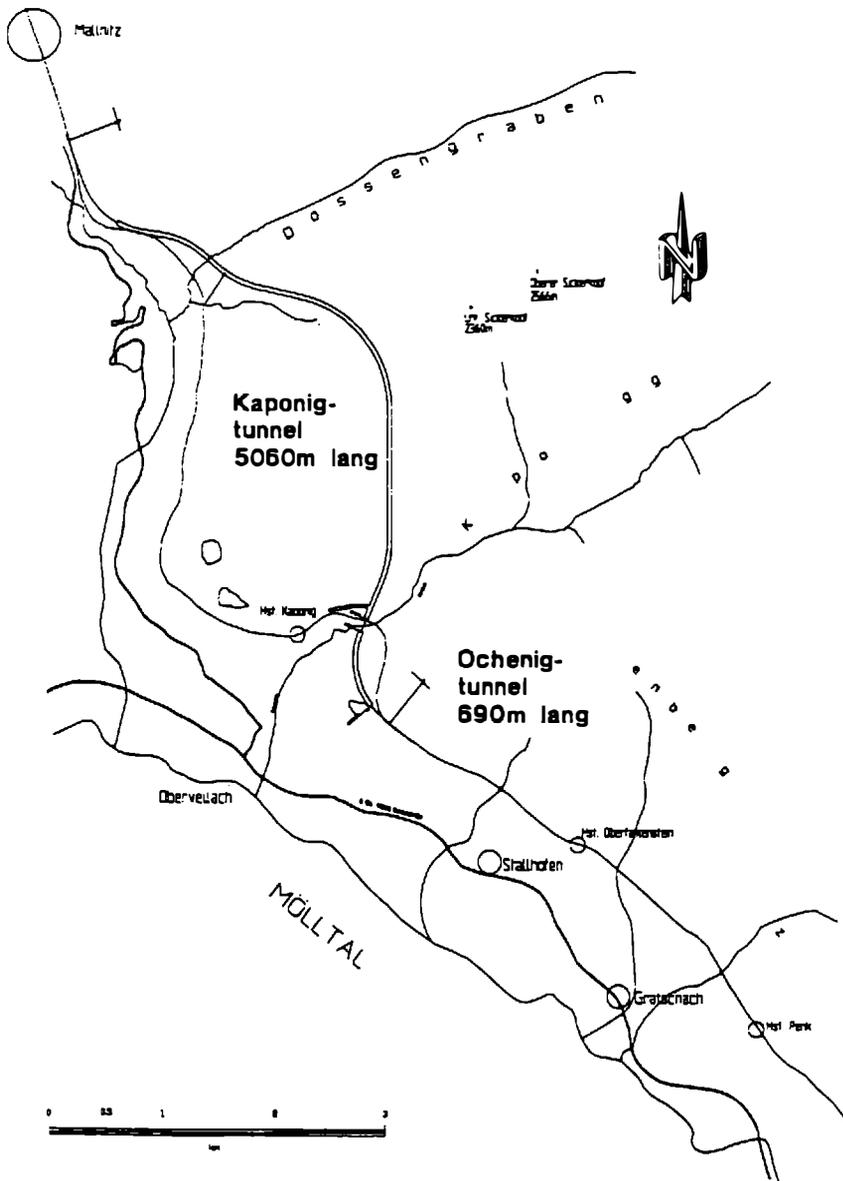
Lageplan mit Bestand und neuer Linienführung
